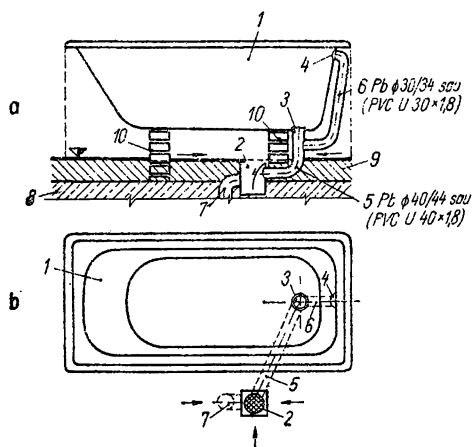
Legarea la canalizare a căzilor de baie cu fund plan pentru înzidit:
